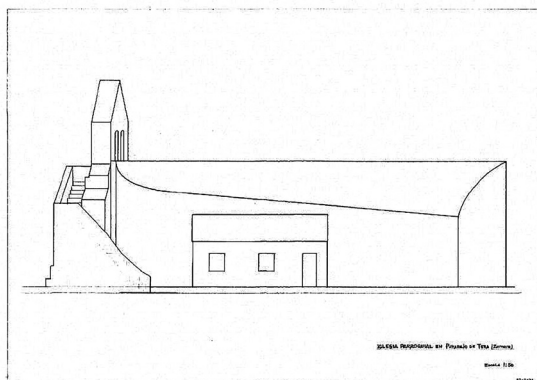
Alzado Sur. Incorpora aún una puerta exterior en la sacristía
